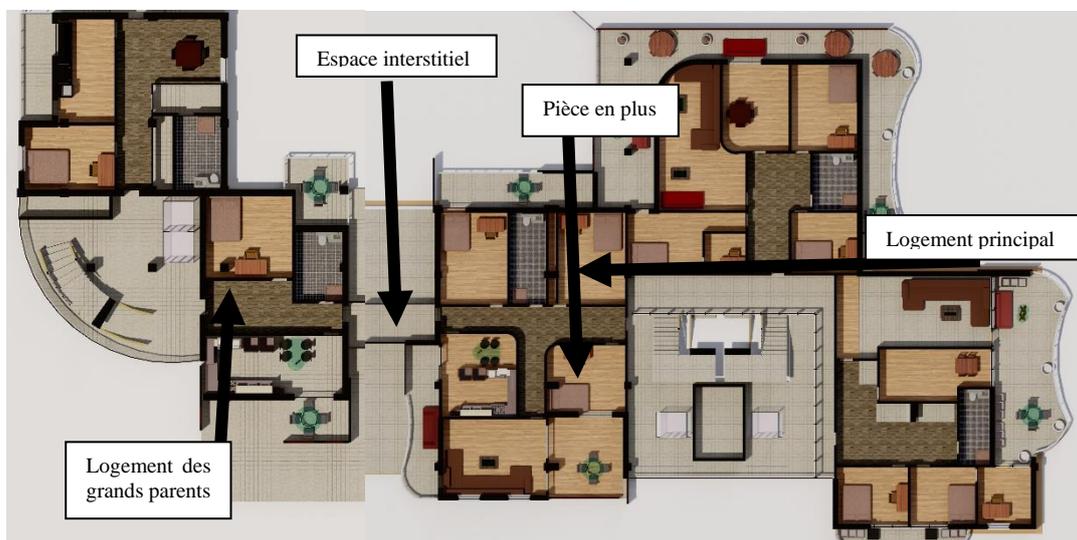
plan de 1er étage de la tour 1. source: travail d'auteur
